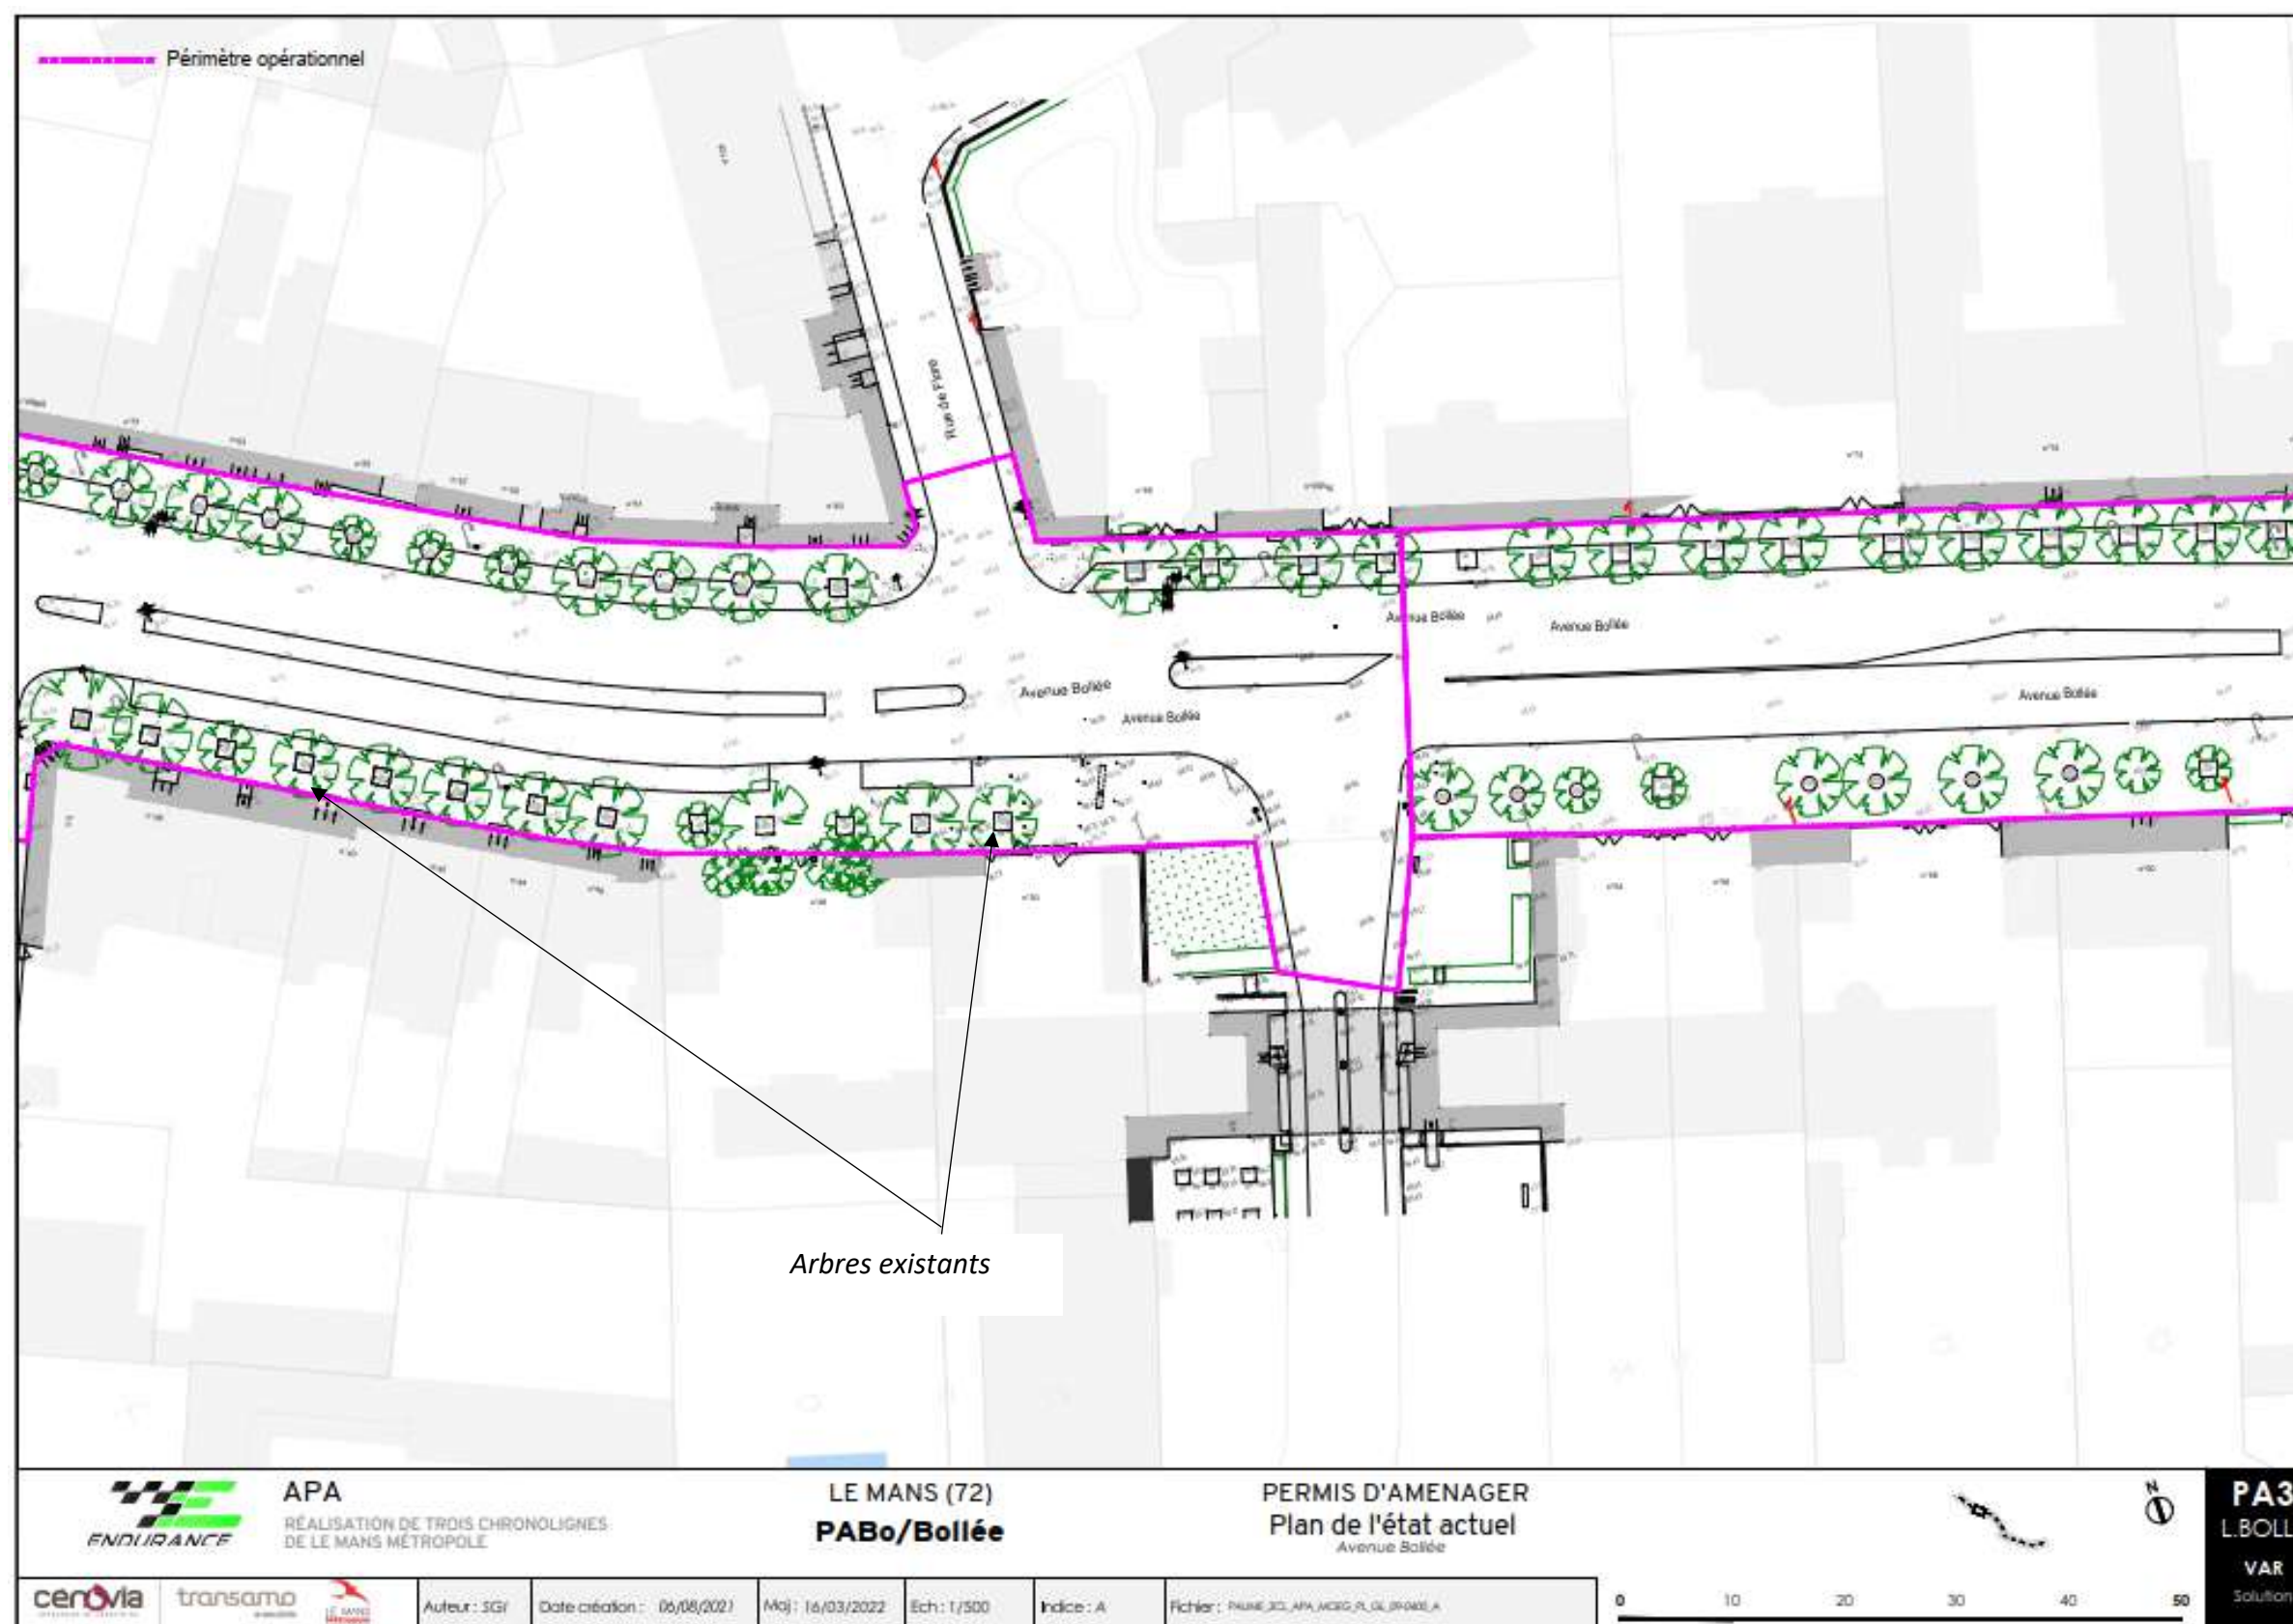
plan topographique actuel avec mise en couleur des arbres existants et du périmètre d'intervention « façade à façade » sur l'Avenue Bollée
